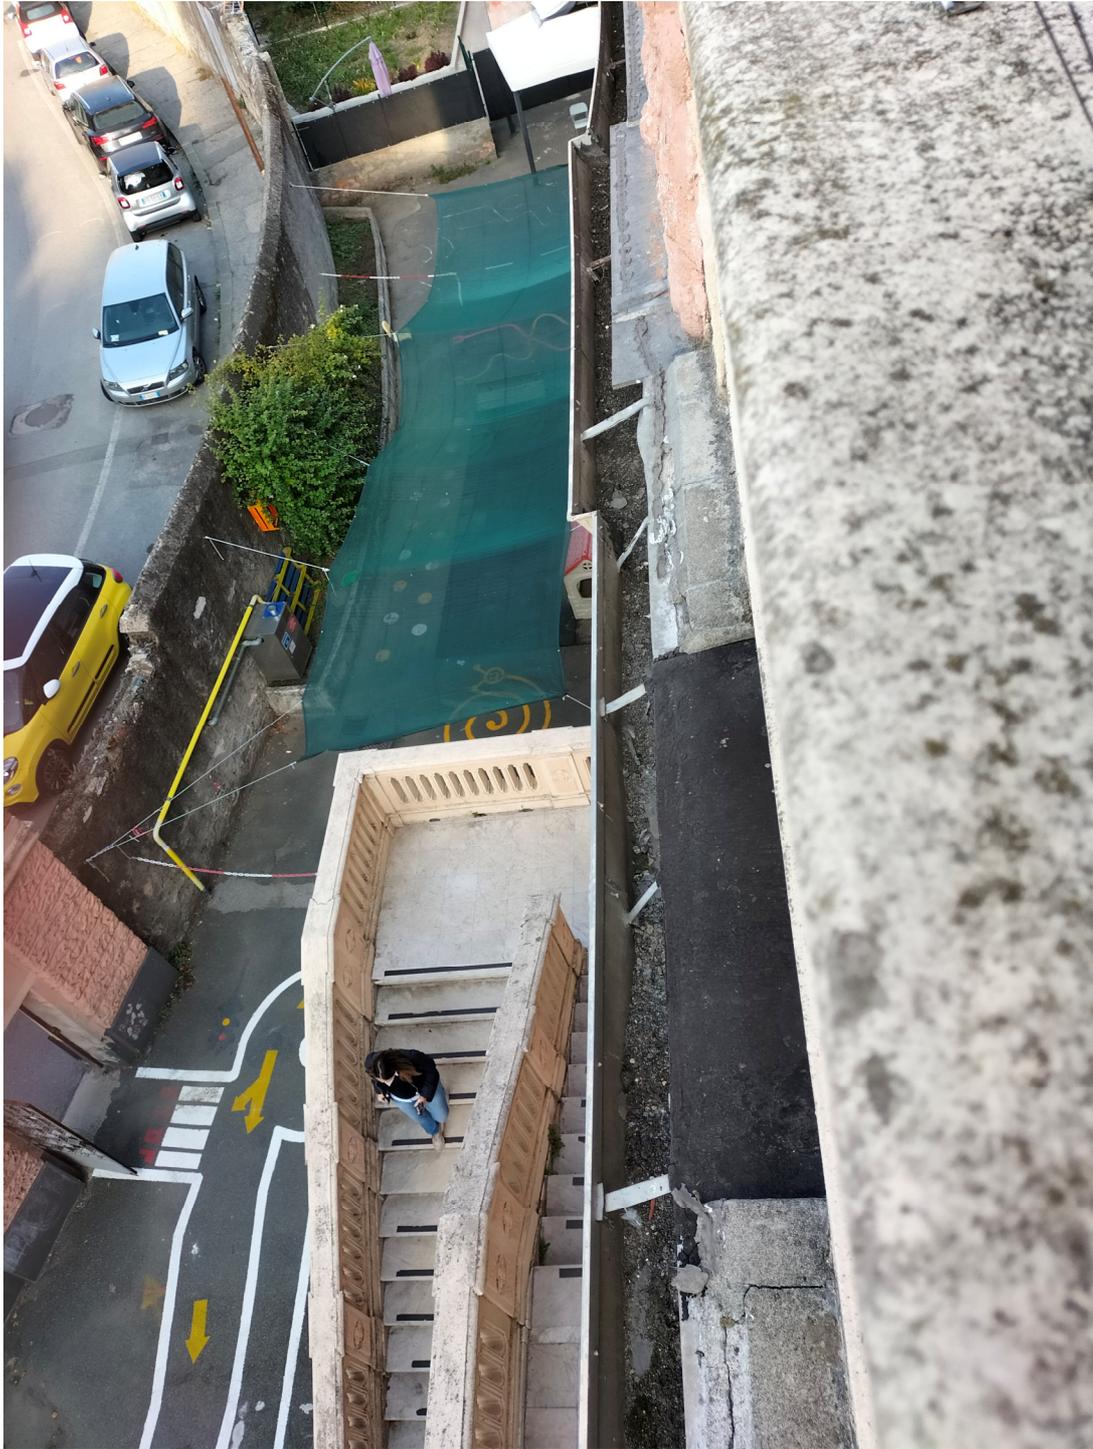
Terrazzo secondo piano: dettaglio della gronda metallica in lamierino che dovrà essere pulita e riparata e dettaglio del cornicione che deve essere restaurato
